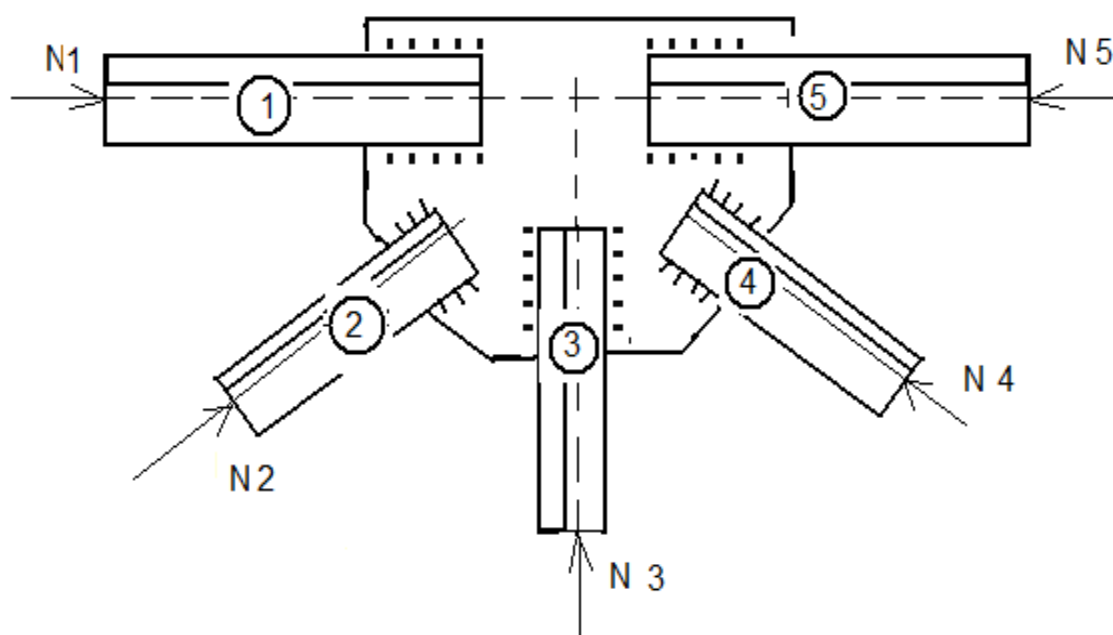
Металева стропильна ферма. Вузол № 3
